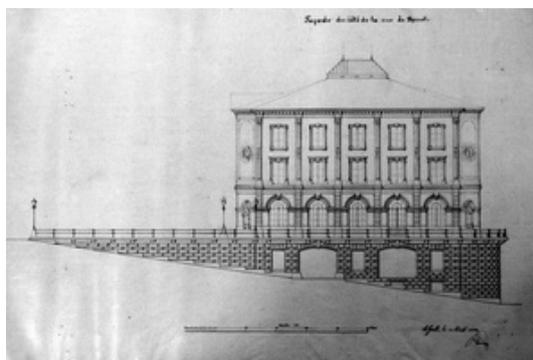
Lausanne, Postgebäude, Plan 9, Aufriss Seitenfassade gegen Rue Pépinet, 1863
